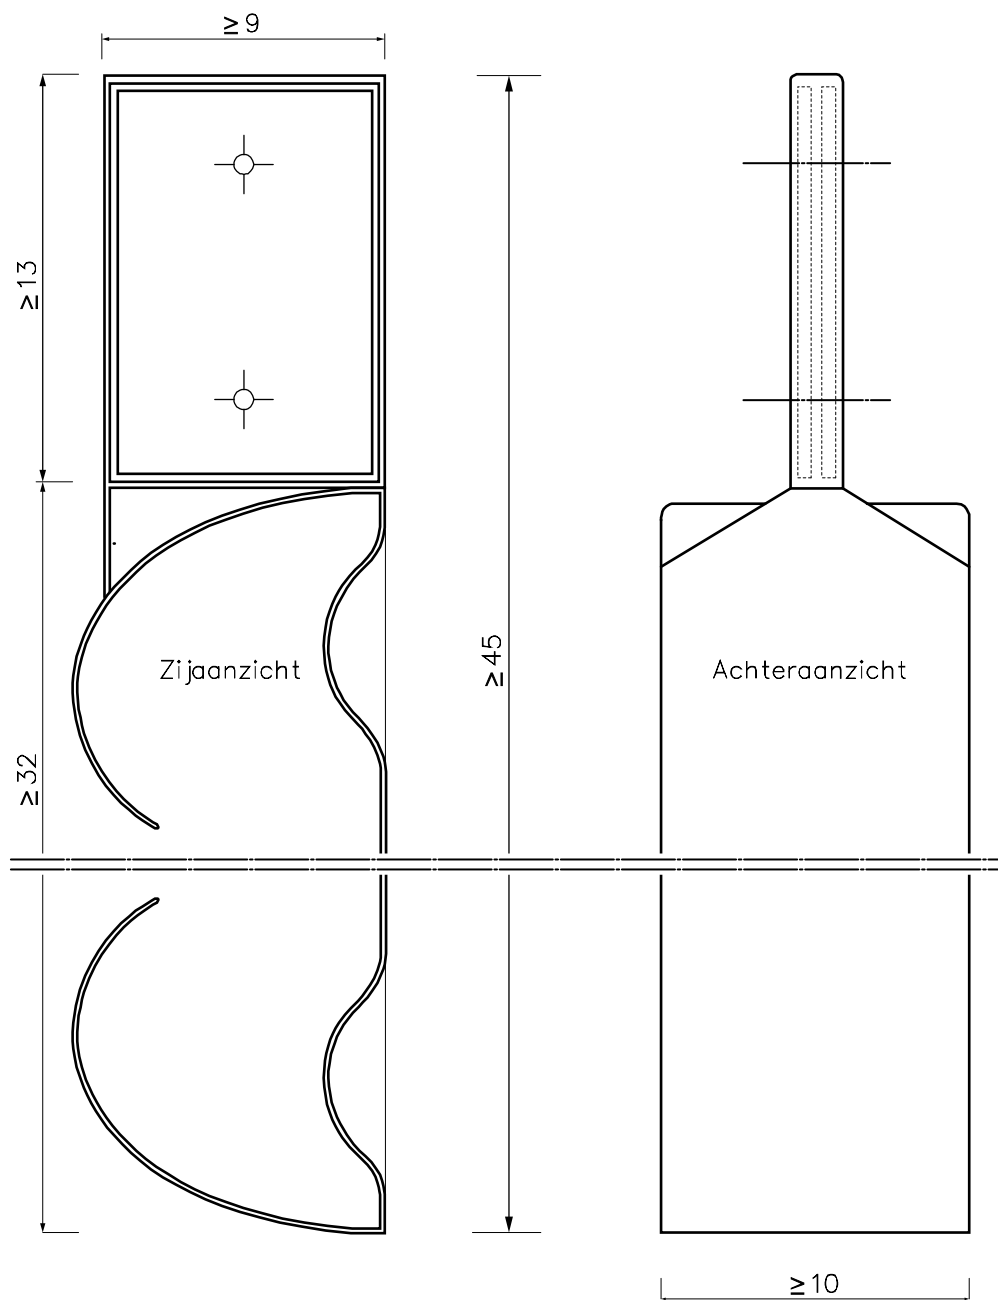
wegabakeningselement voor betonnen afschermende constructie – type 2
